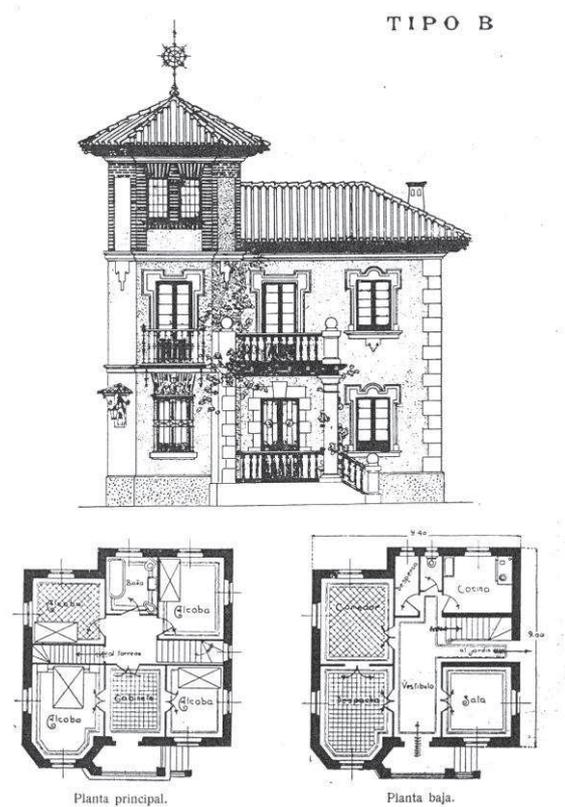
Planta vivienda para suboficiales y sargentos. Ante proyecto del T.C. de Ingenieros Antonio Arenas Ramos. 1928
